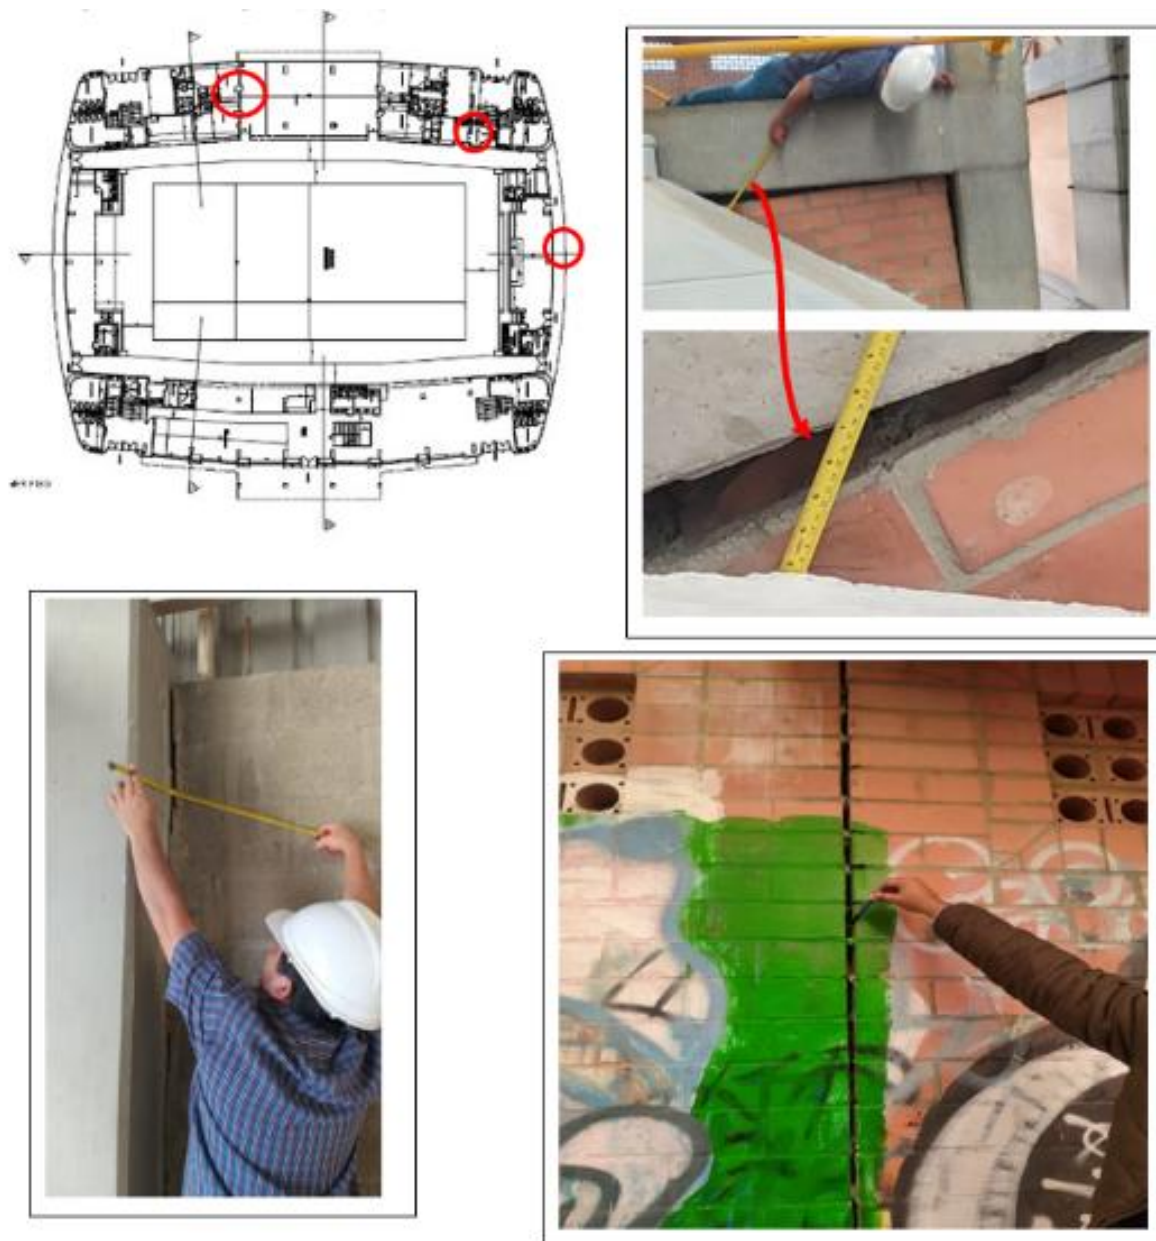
Grietas por des colgamiento de muro interior y exteriores en mampostería en 1,2,3 pisos.
